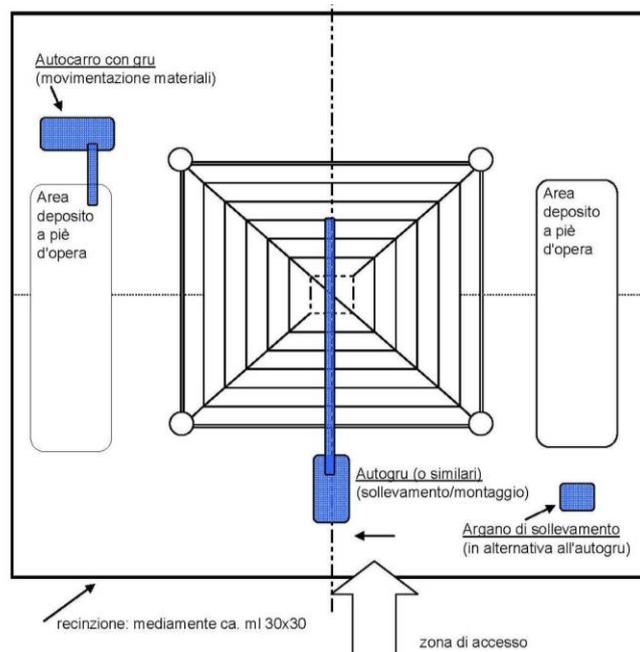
Planimetria dell'area di microcantiere (linea 380 kV) - fase di lavoro: montaggio sostegno
